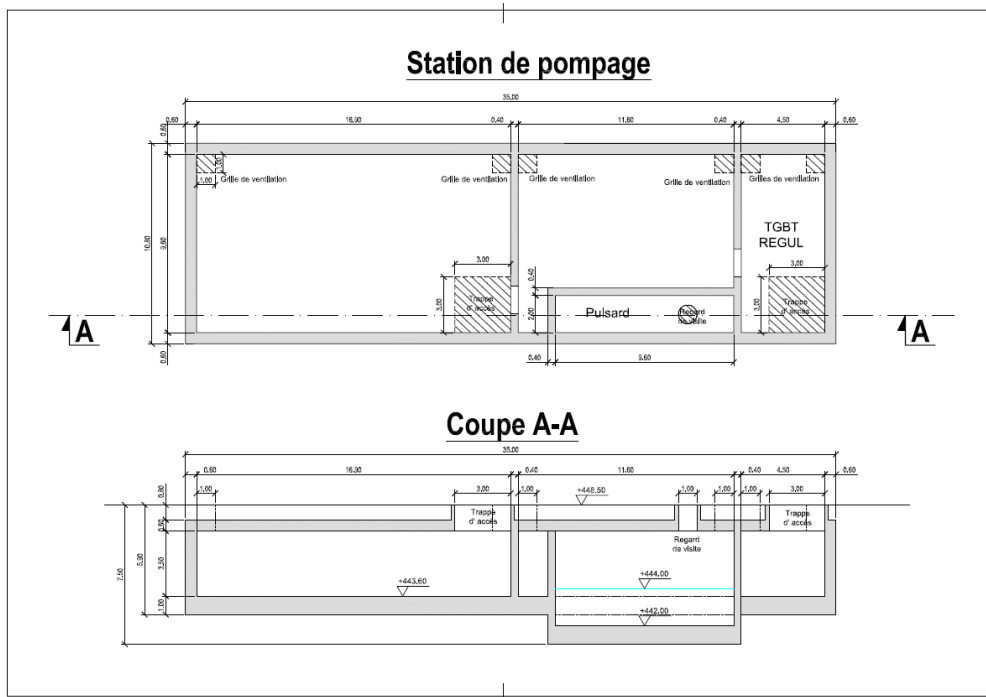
Plan et coupe de la station de pompage (Source : IDEX-SGI)
